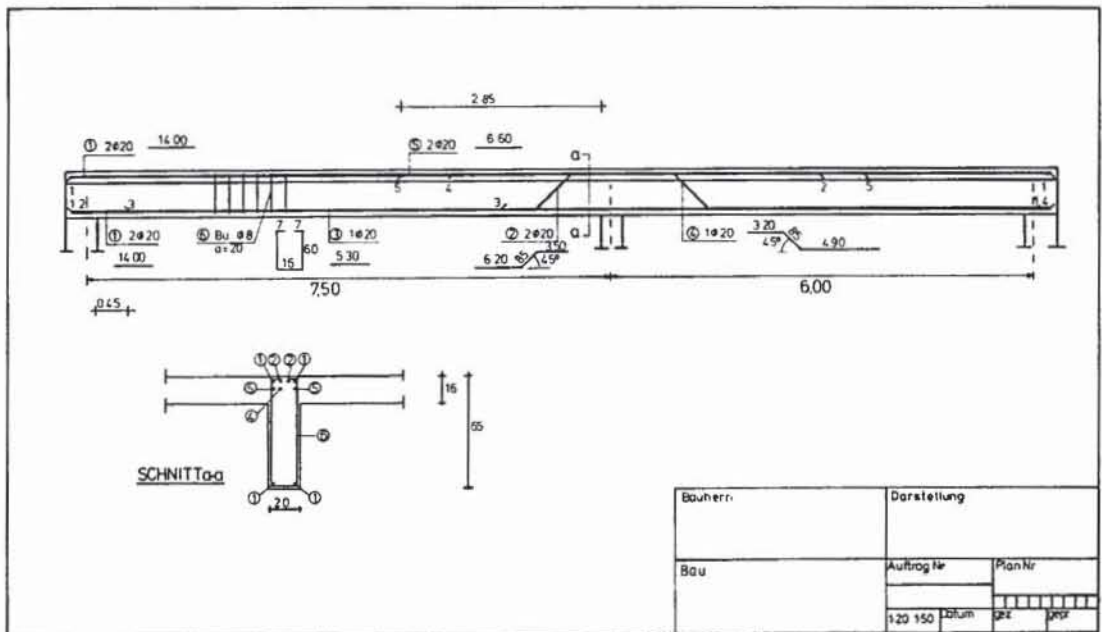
Vereinfachter Bewehrungsplan für einen Zweifeldträger nach Bild 3
